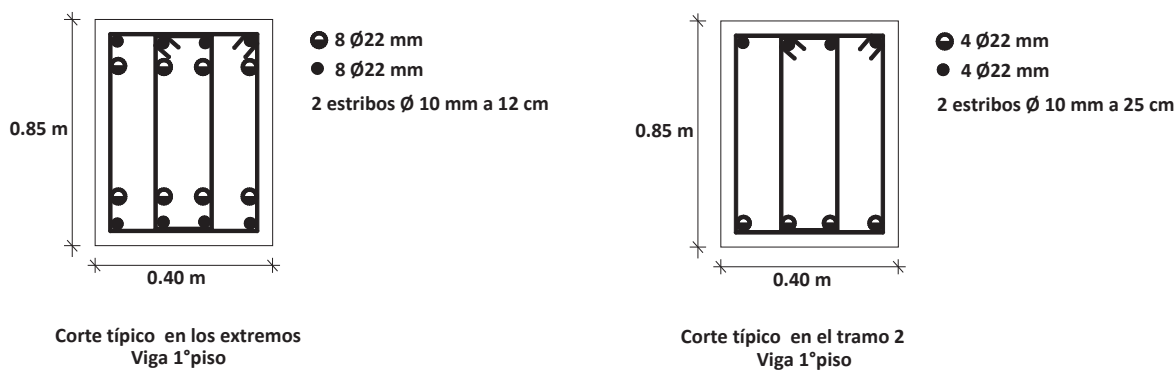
Armado típico de vigas del 1º piso, en las zonas de articulación plástica y en el centro del claro.
